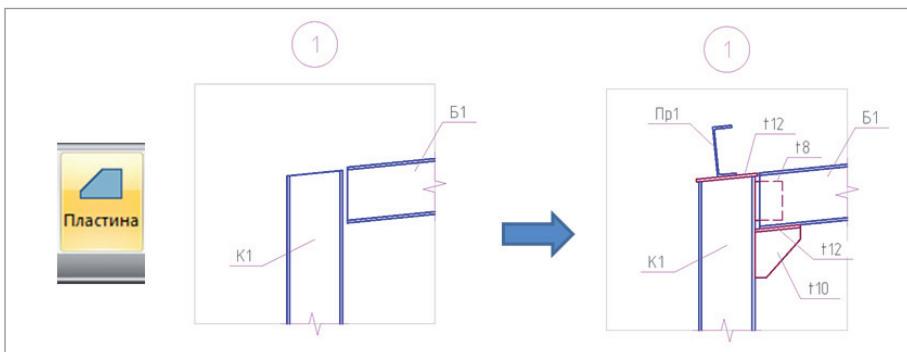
Подрезка торца балки и установка дополнительных элементов из пластин
